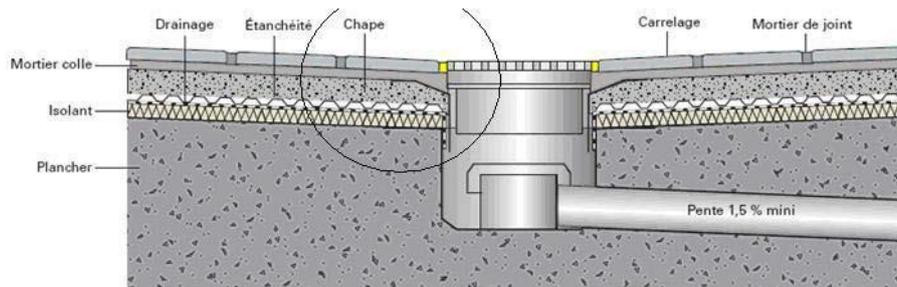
Schéma de principe d'un raccord d'étanchéité sous la chape au niveau inférieur du siphon.
